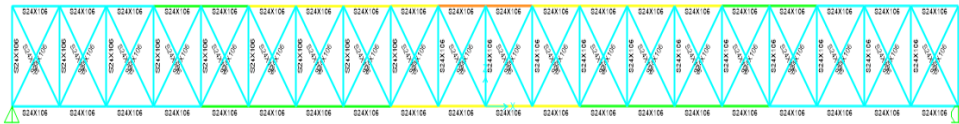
Chequeo de la estructura con la sección S24x106.
